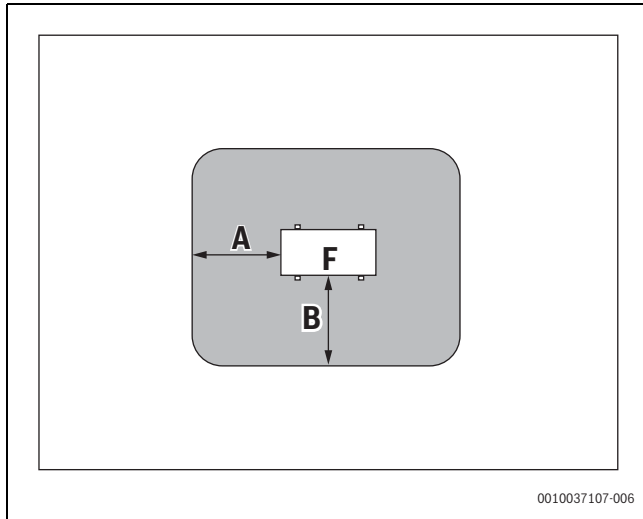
Zona di sicurezza per installazione a basamento sul terreno di pertinenza o sul tetto
